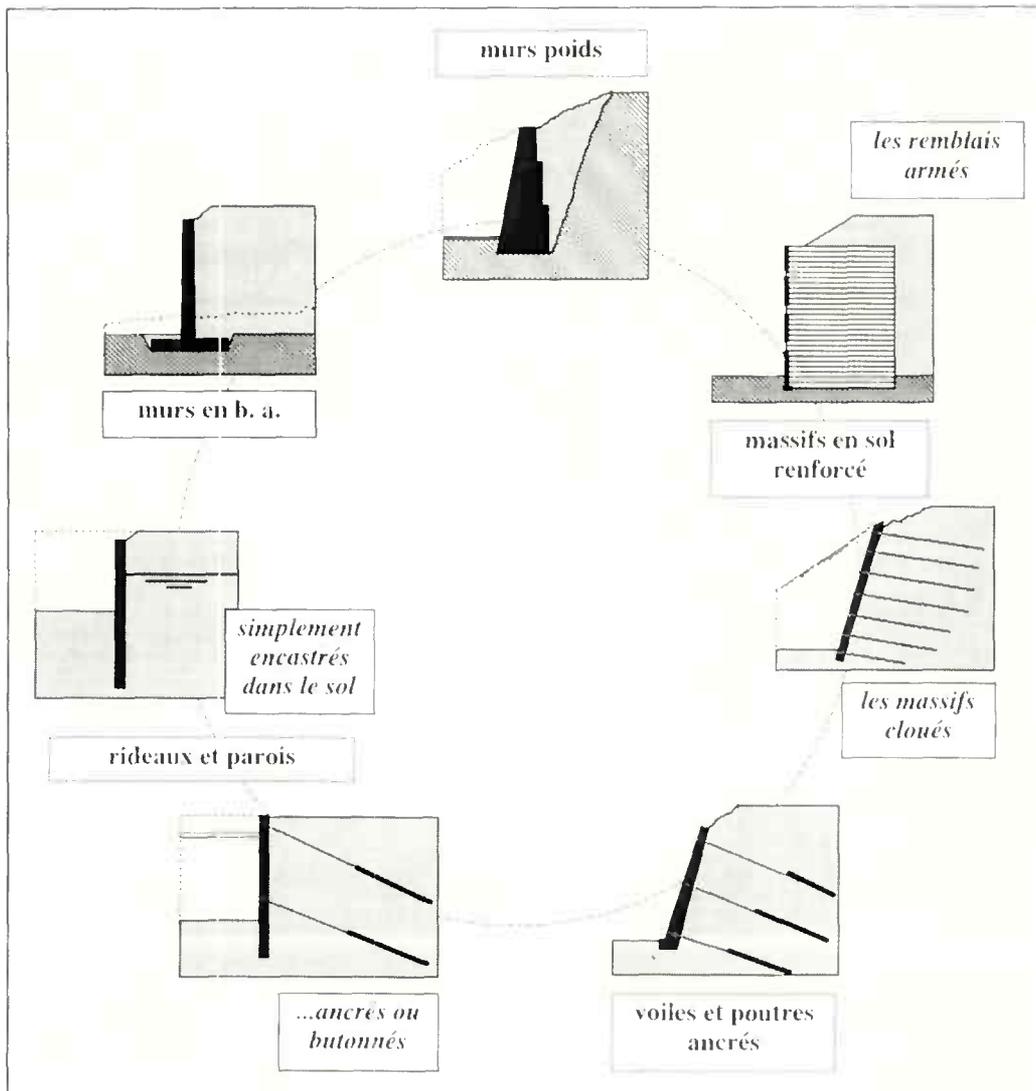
Les principales familles d'ouvrages de soutènement
